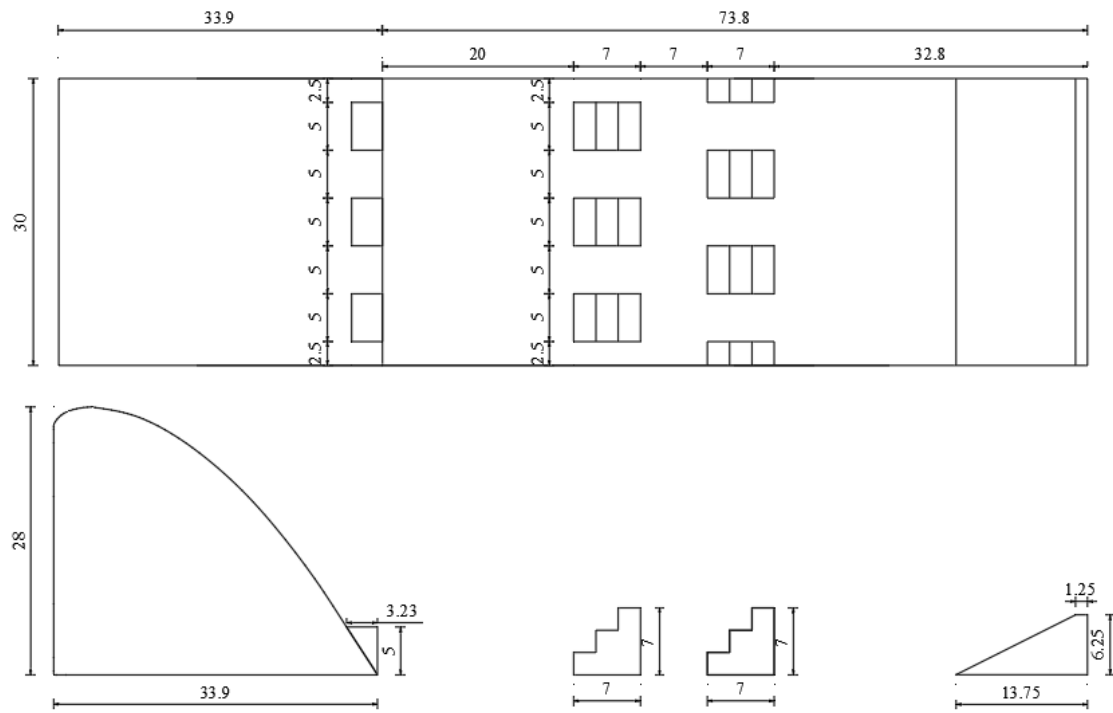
T kesitli tek sıra enerji kırıcı blokların yerleşim planı
